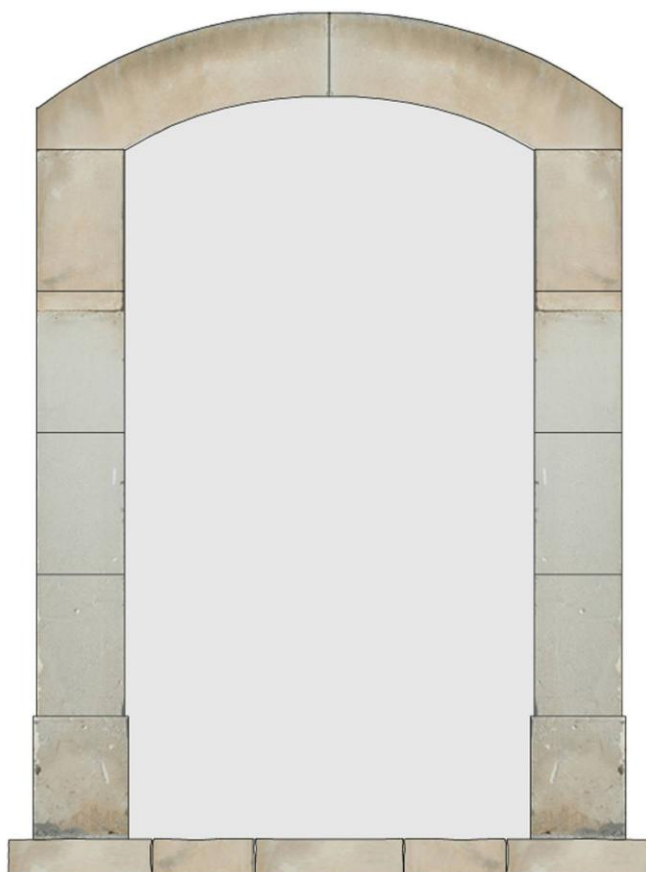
Portale con arco basso in cornici di pietra senza concio centrale. Blocchi all'imposta dell'arco e alla base delle spalle in pietra non decorate, spalle in blocchi di pietra squadrate. Soglia in blocchi di pietra irregolarmente squadrate.
